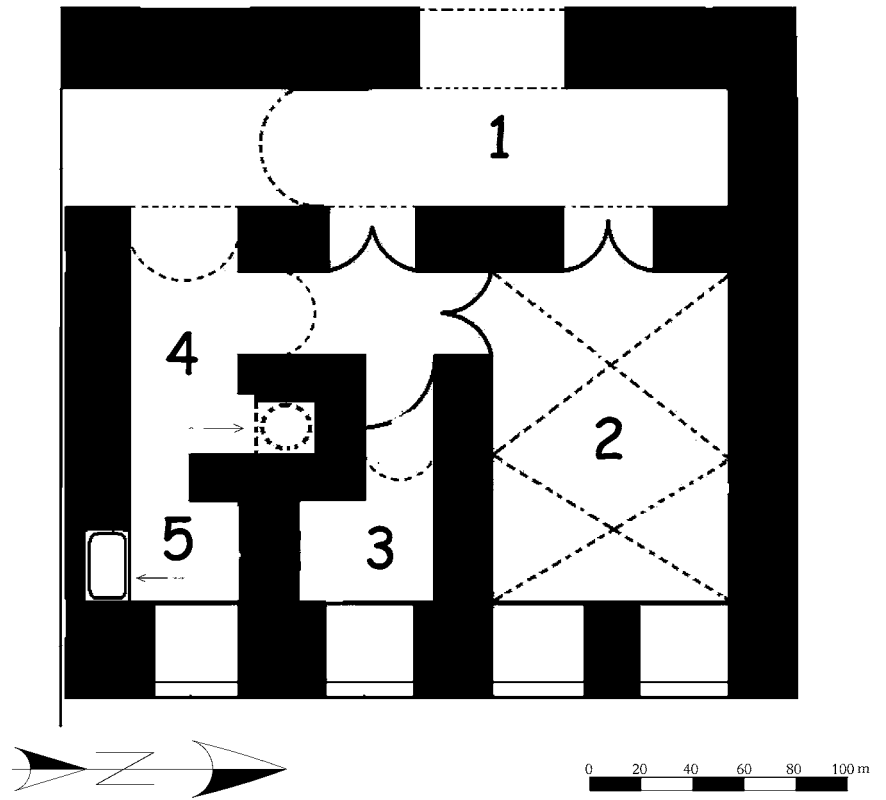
قصر علي باشا بن عون، مسقط أفقي للطابق الثاني. (عمل بمعرفة الباحث)
